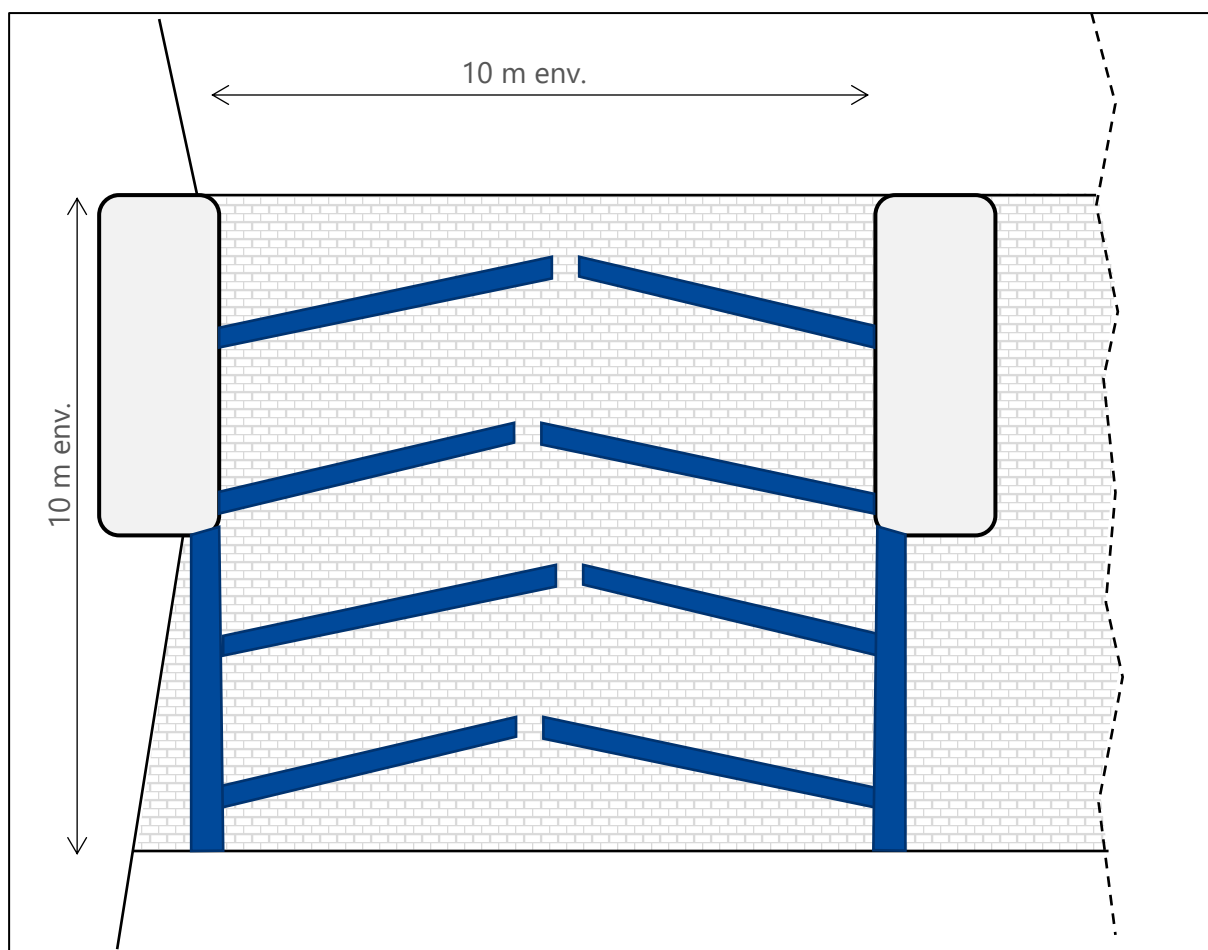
Schéma d'installation de la passe à poisson de l'aménagement 17
